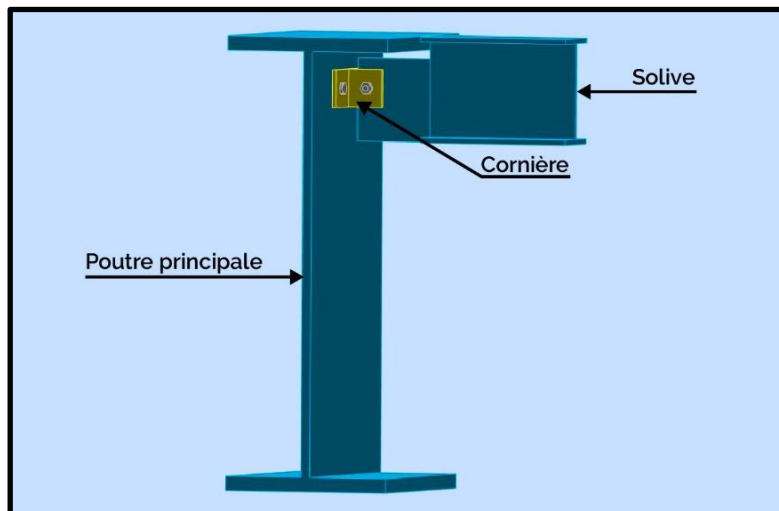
Assemblage poutre IPE 600 – solive IPE 140
